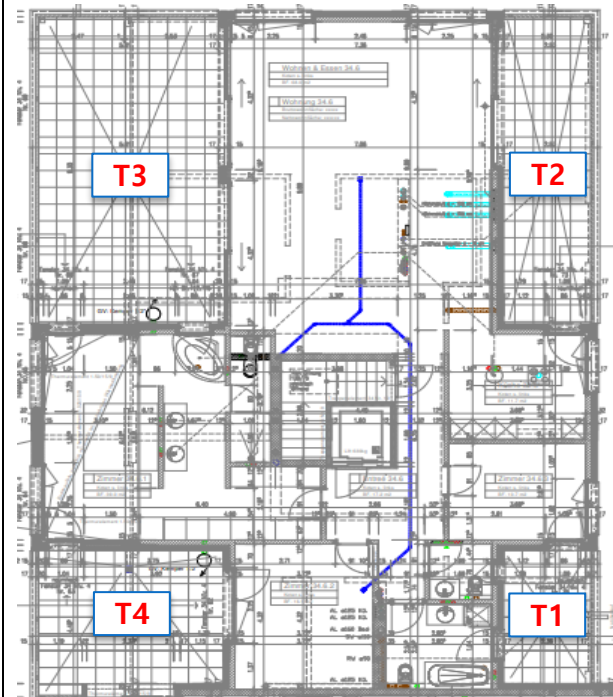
Haus 34 Dachgeschoss | Übersicht
